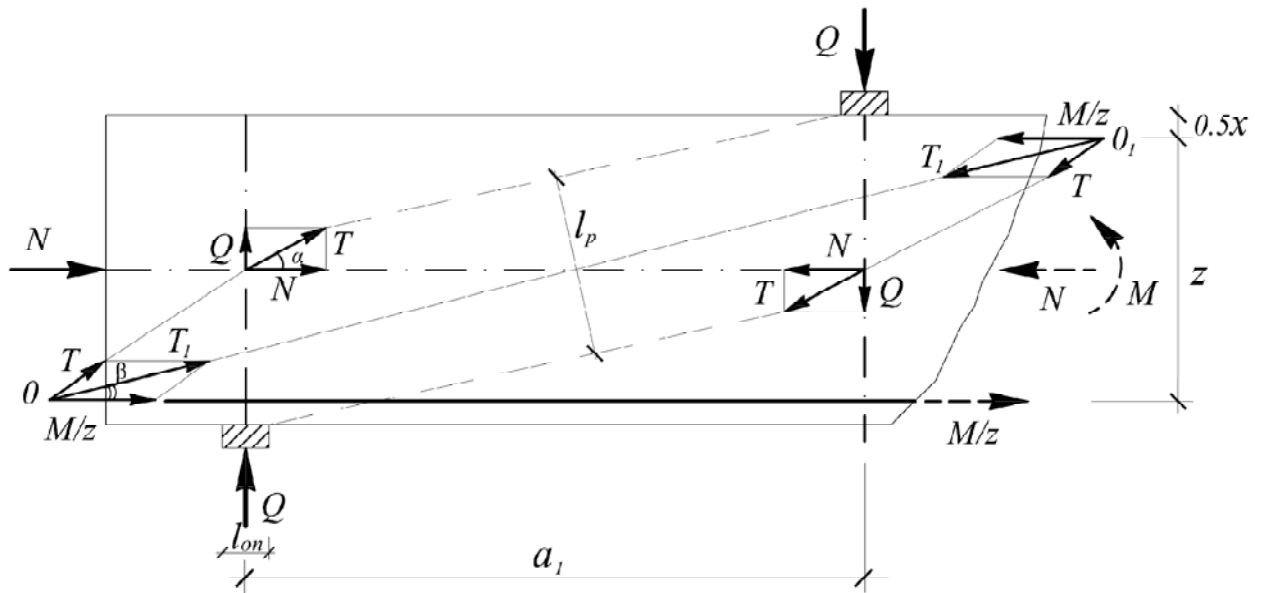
Расчетная схема железобетонных элементов при поперечном изгибе с продольными сжимающими силами высокого уровня (при отсутствии сжатой арматуры).
